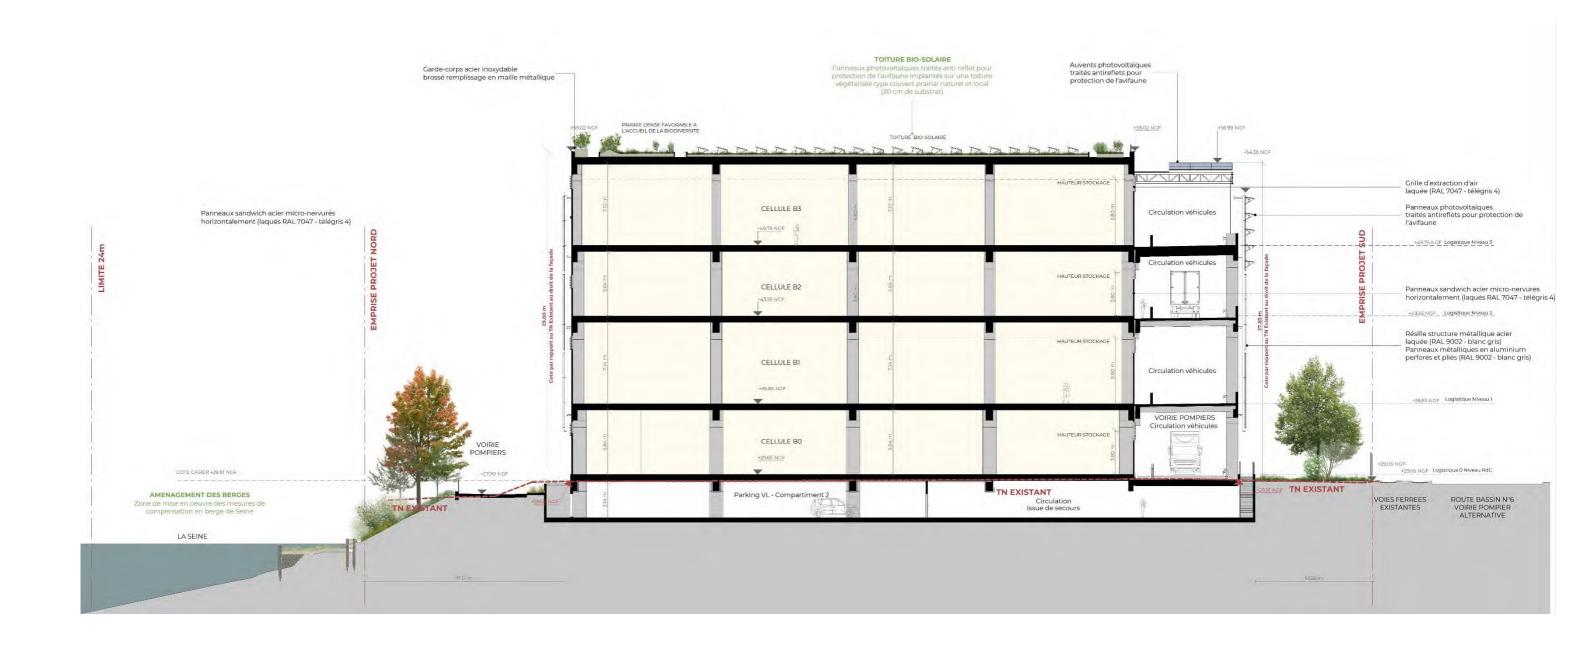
Plans de coupe du futur projet Green dock (Source : A26)
